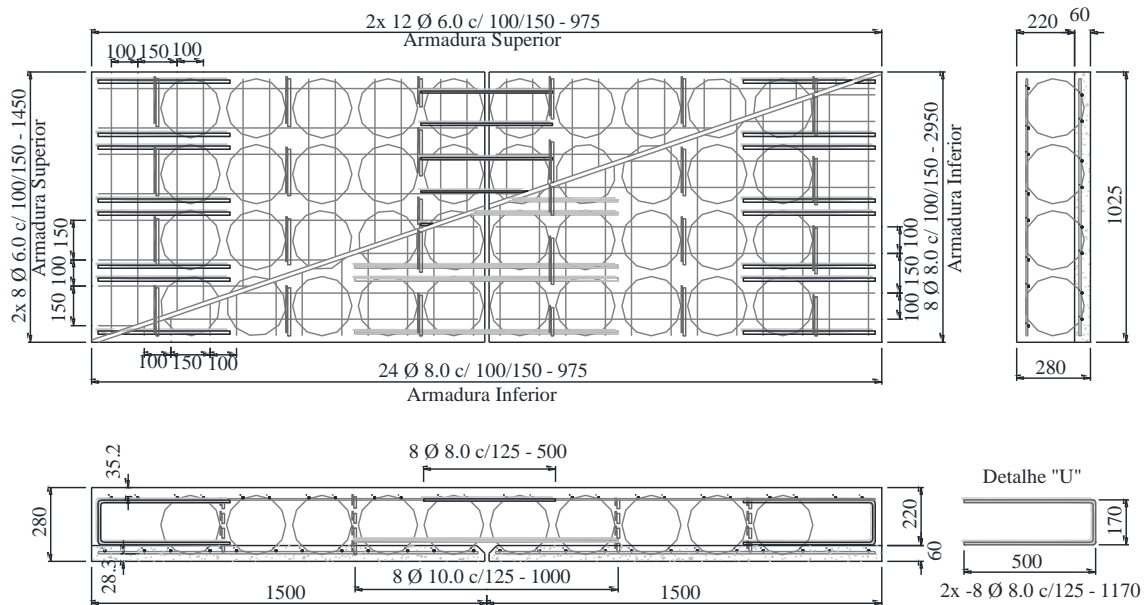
Detalhamento das armaduras de flexão da laje BD28-F2 (dimensões em mm).
